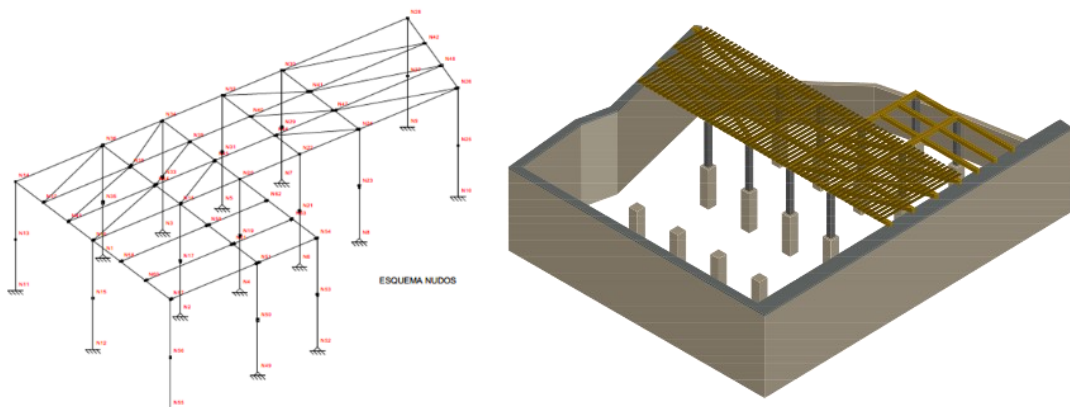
Esquema de estructura de cubierta e infografía. Fuente: MITECO (2022)
